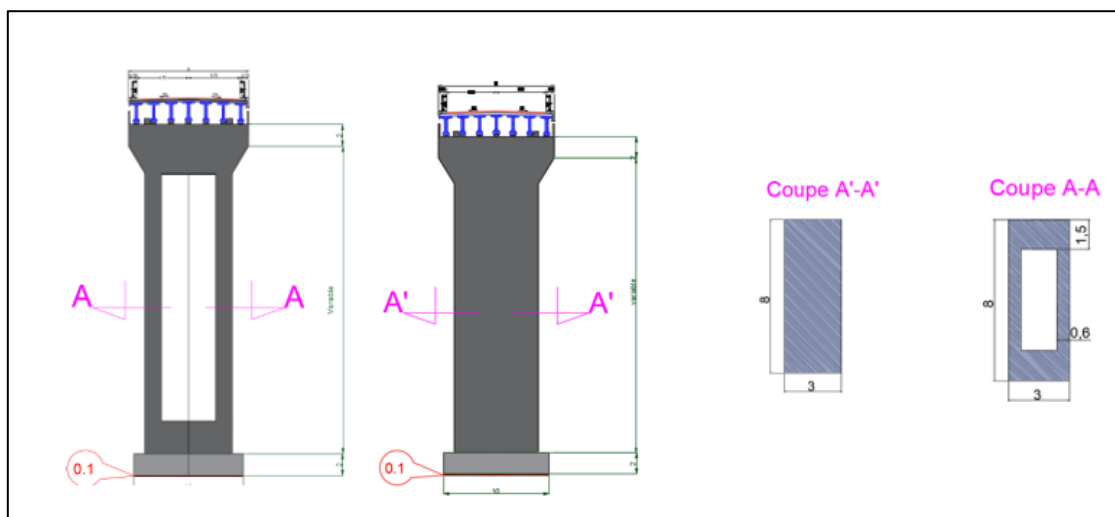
la coupe transversale et en plan de la pile pleine et évidée
